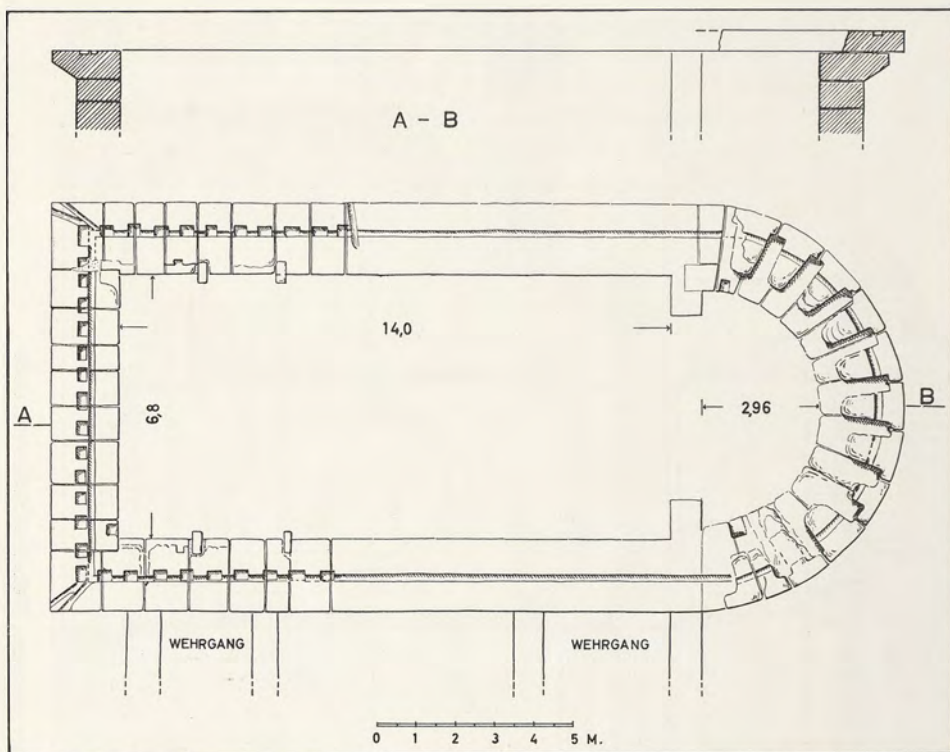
Porta Nigra. Oberer Abschluß des Westturmes; Grundriß und Schnitt
